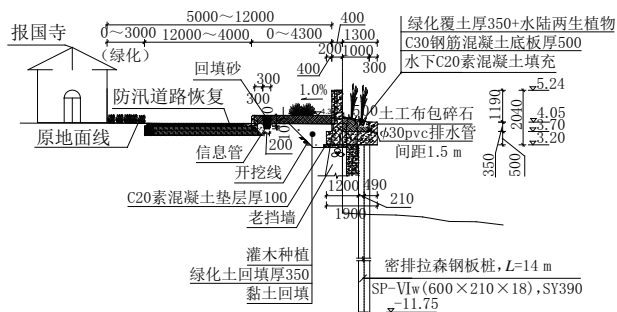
拆除重建低桩承台典型断面(尺寸单位:cm;高程单位:m)
